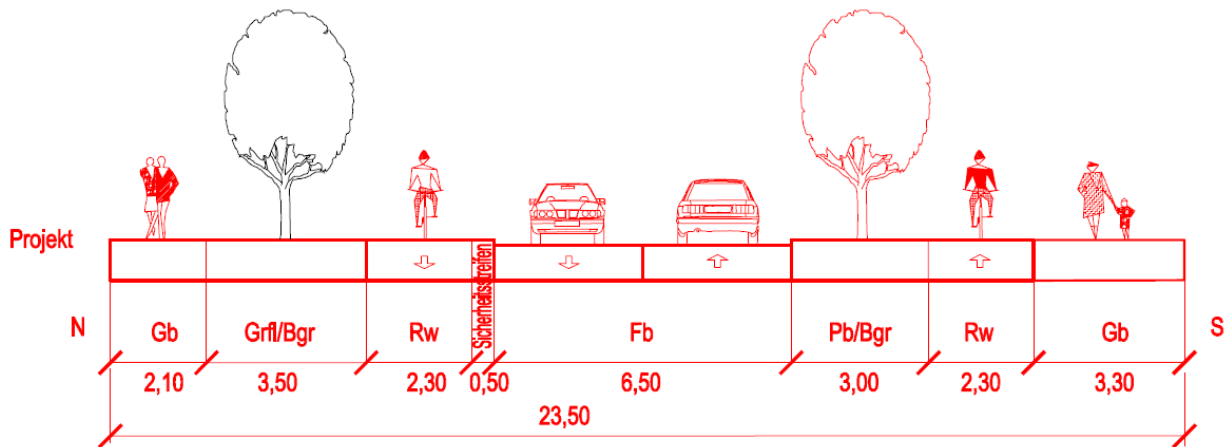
Schematische Darstellung Planung Vorzugsvariante Querschnitt Truderinger Straße zw. Schwanhildeweg und Roßsteinstraße; (Quelle: Ing.-Büro Dr. Zimmermann)
